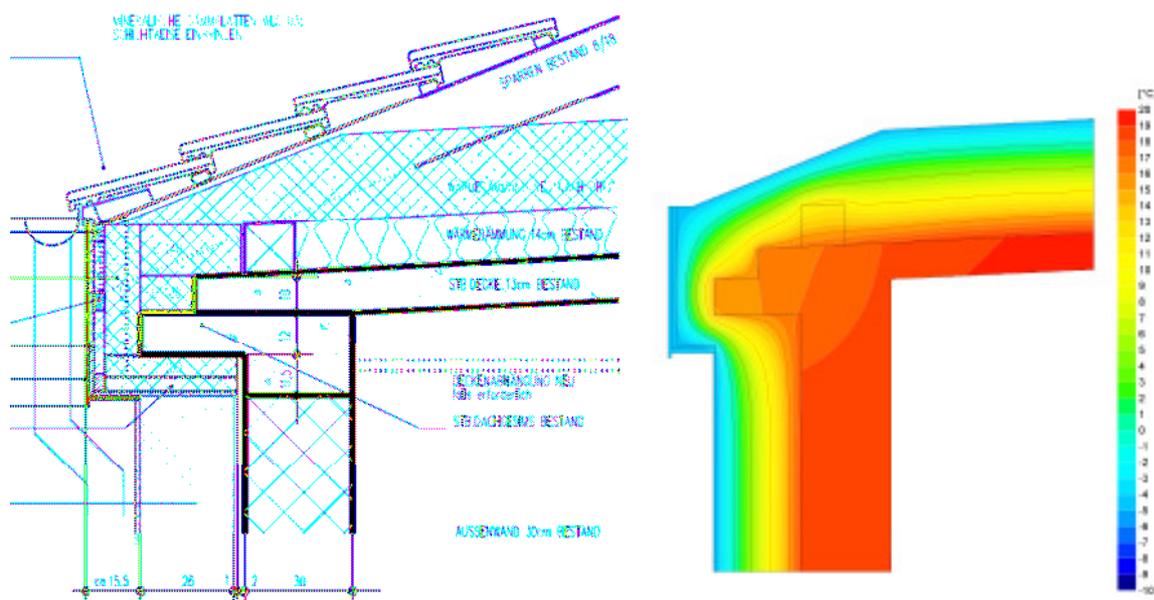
Wärmebrückenreduktion am Dachrand beim Gebäude Schlesierstraße. Links: Das Gesims konnte nicht entfernt werden und musste deshalb mit Wärmedämmung eingepackt werden. Rechts: zweidimensionale Wärmeströmberechnung zur Bestimmung der minimal zu erwartenden Oberflächentemperaturen an den Innenoberflächen.
